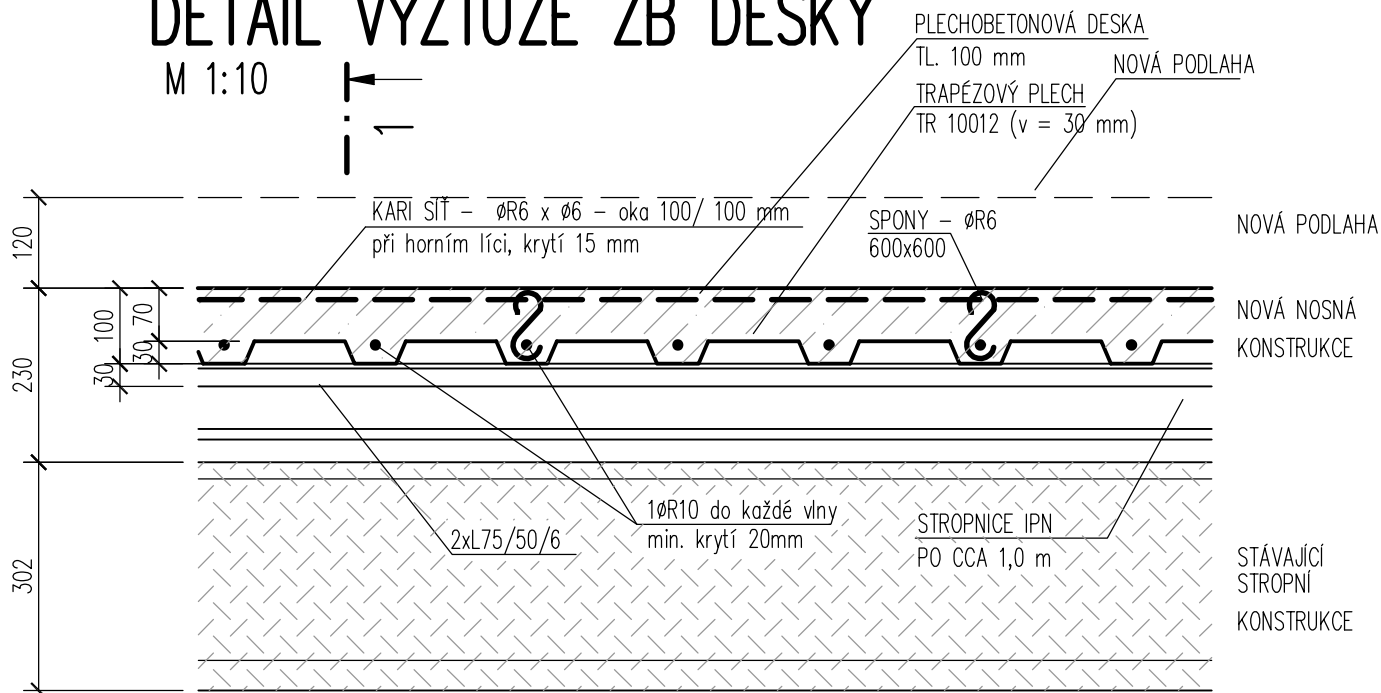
" – VZOROVÝ DETAIL DETAIL VÝZTUŽE ŽB DESKY
